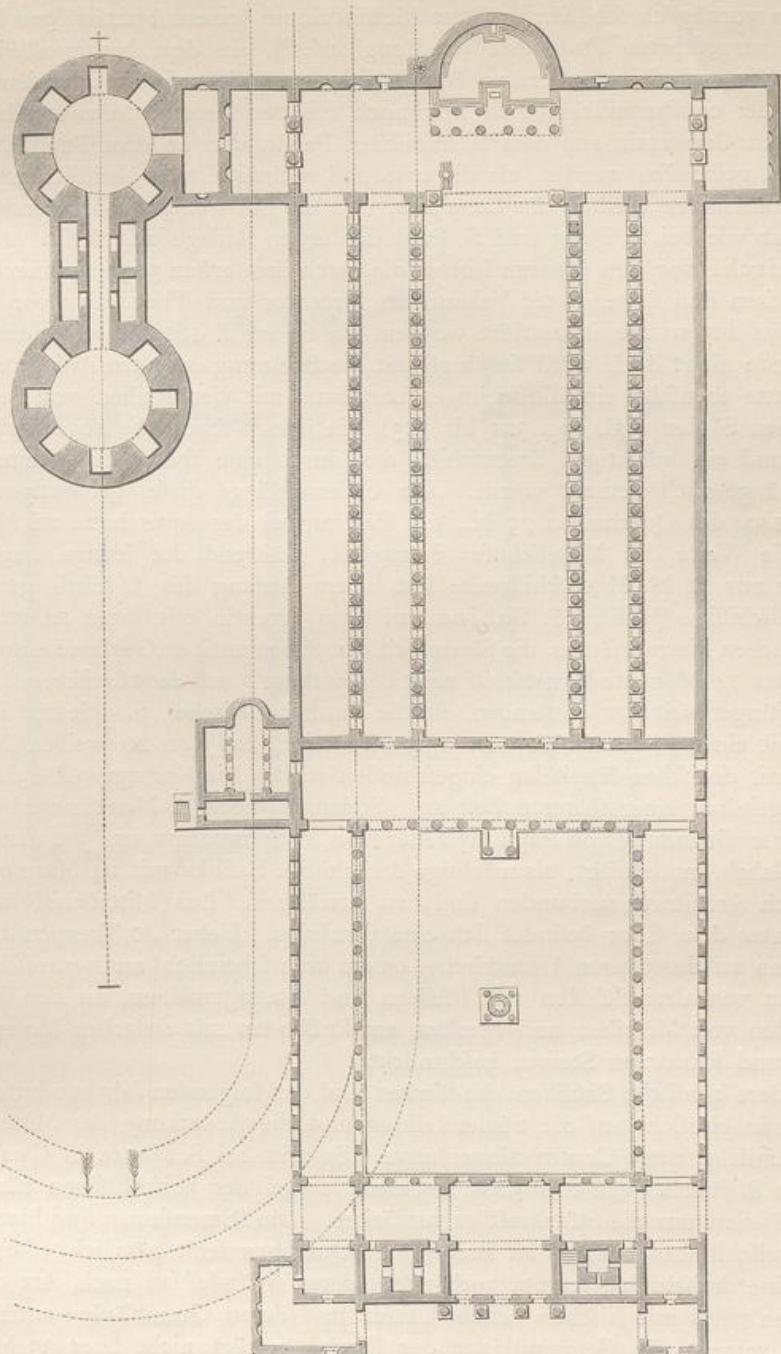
Grundriss der alten Peterskirche zu Rom.
